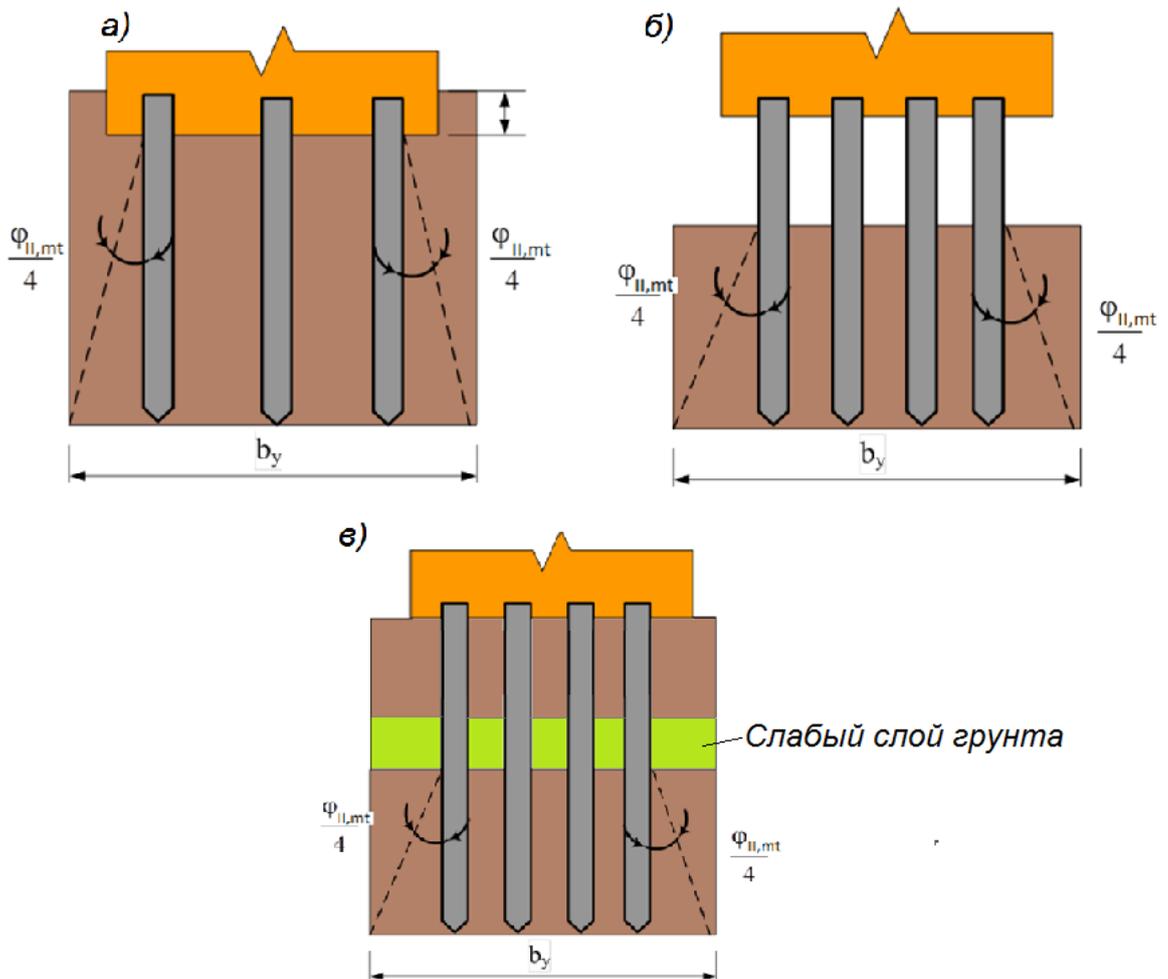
Определение границ условного фундамента: а) – для низкого ростверка; б) - для высокого ростверка; в) – при наличии слабой прослойки грунта.
